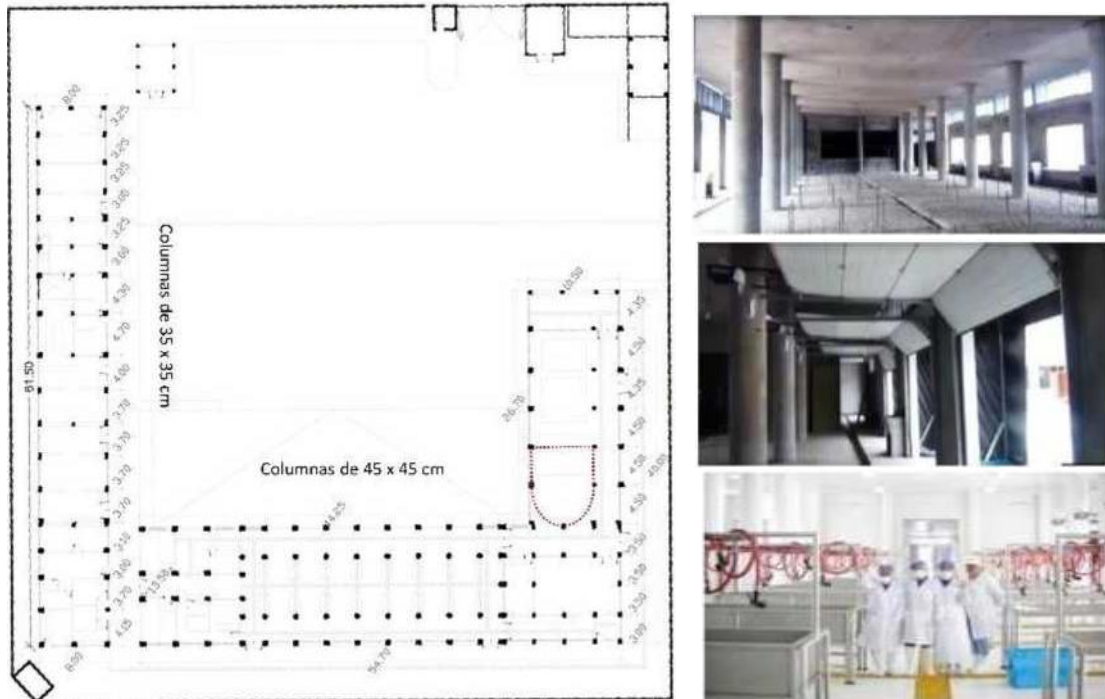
Sistema Estructural. Fuente: Fondo Nacional de Desarrollo Pesquero
